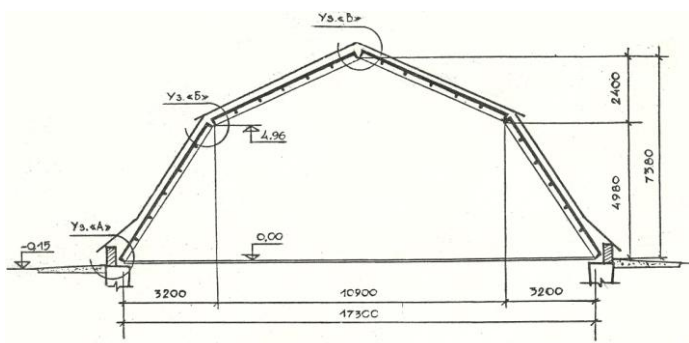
Поперечних безкаркасного сільсько-господарської будівлі універсального призначення
